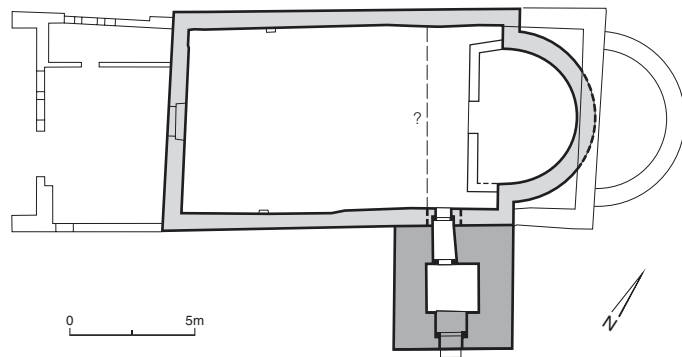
Leissigen. Änderungen in der Nutzungszeit der Apsisanlage. Rekonstruierter Grundriss nach dem Anbau des Turmes. M 1:300.
